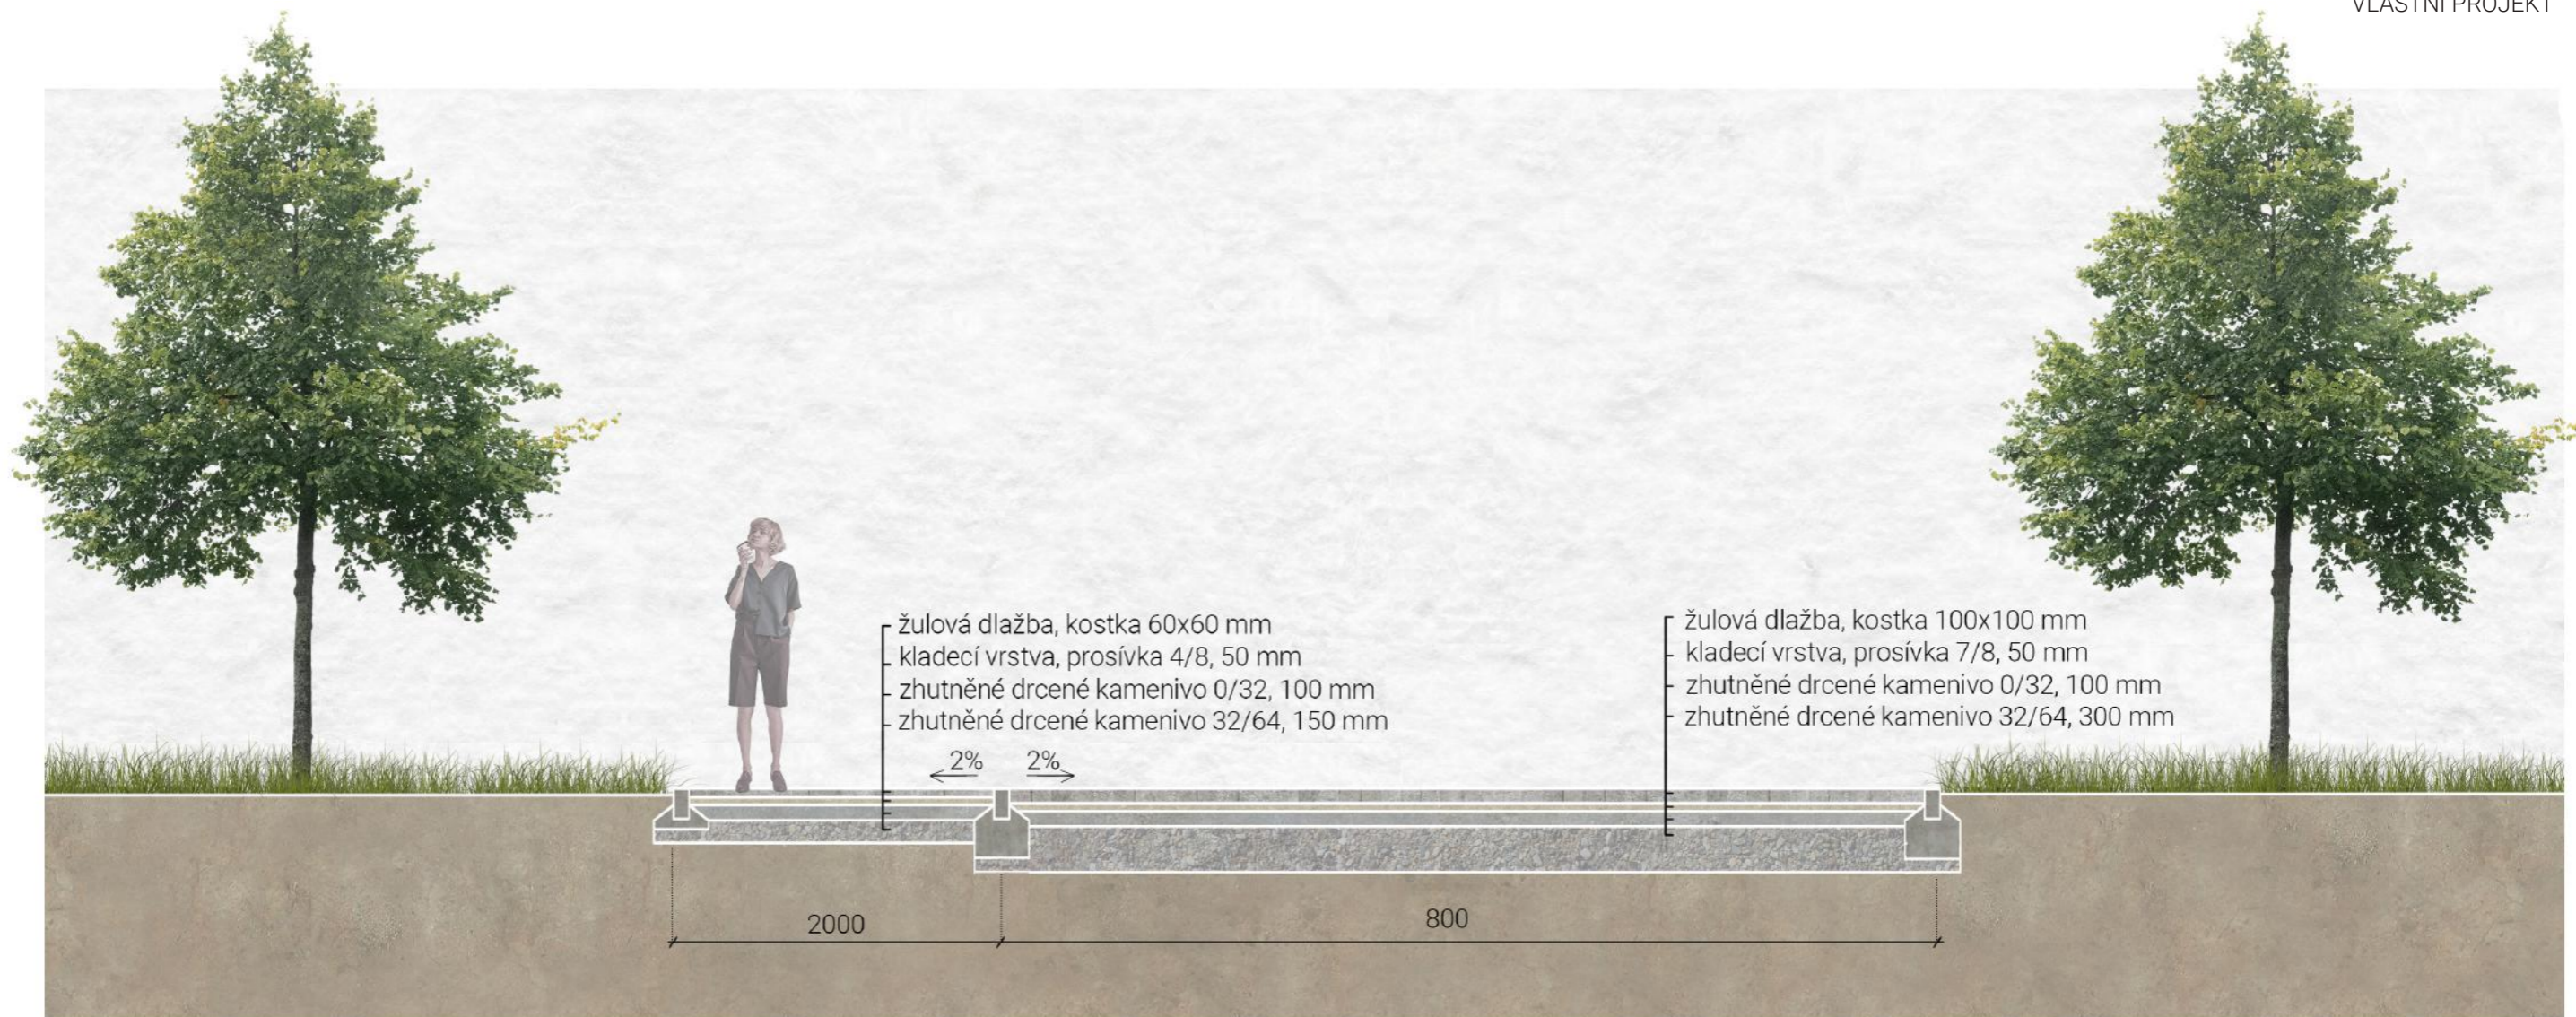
Technický detail, řez mlatovou cestou (autorka 2024).
